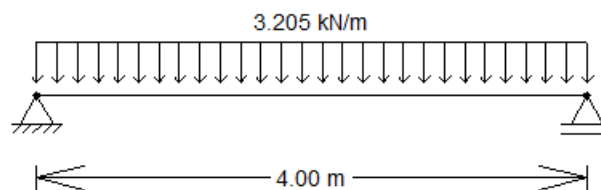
Sistema estático da viga 3 ou 4 com esforço do cálculo
